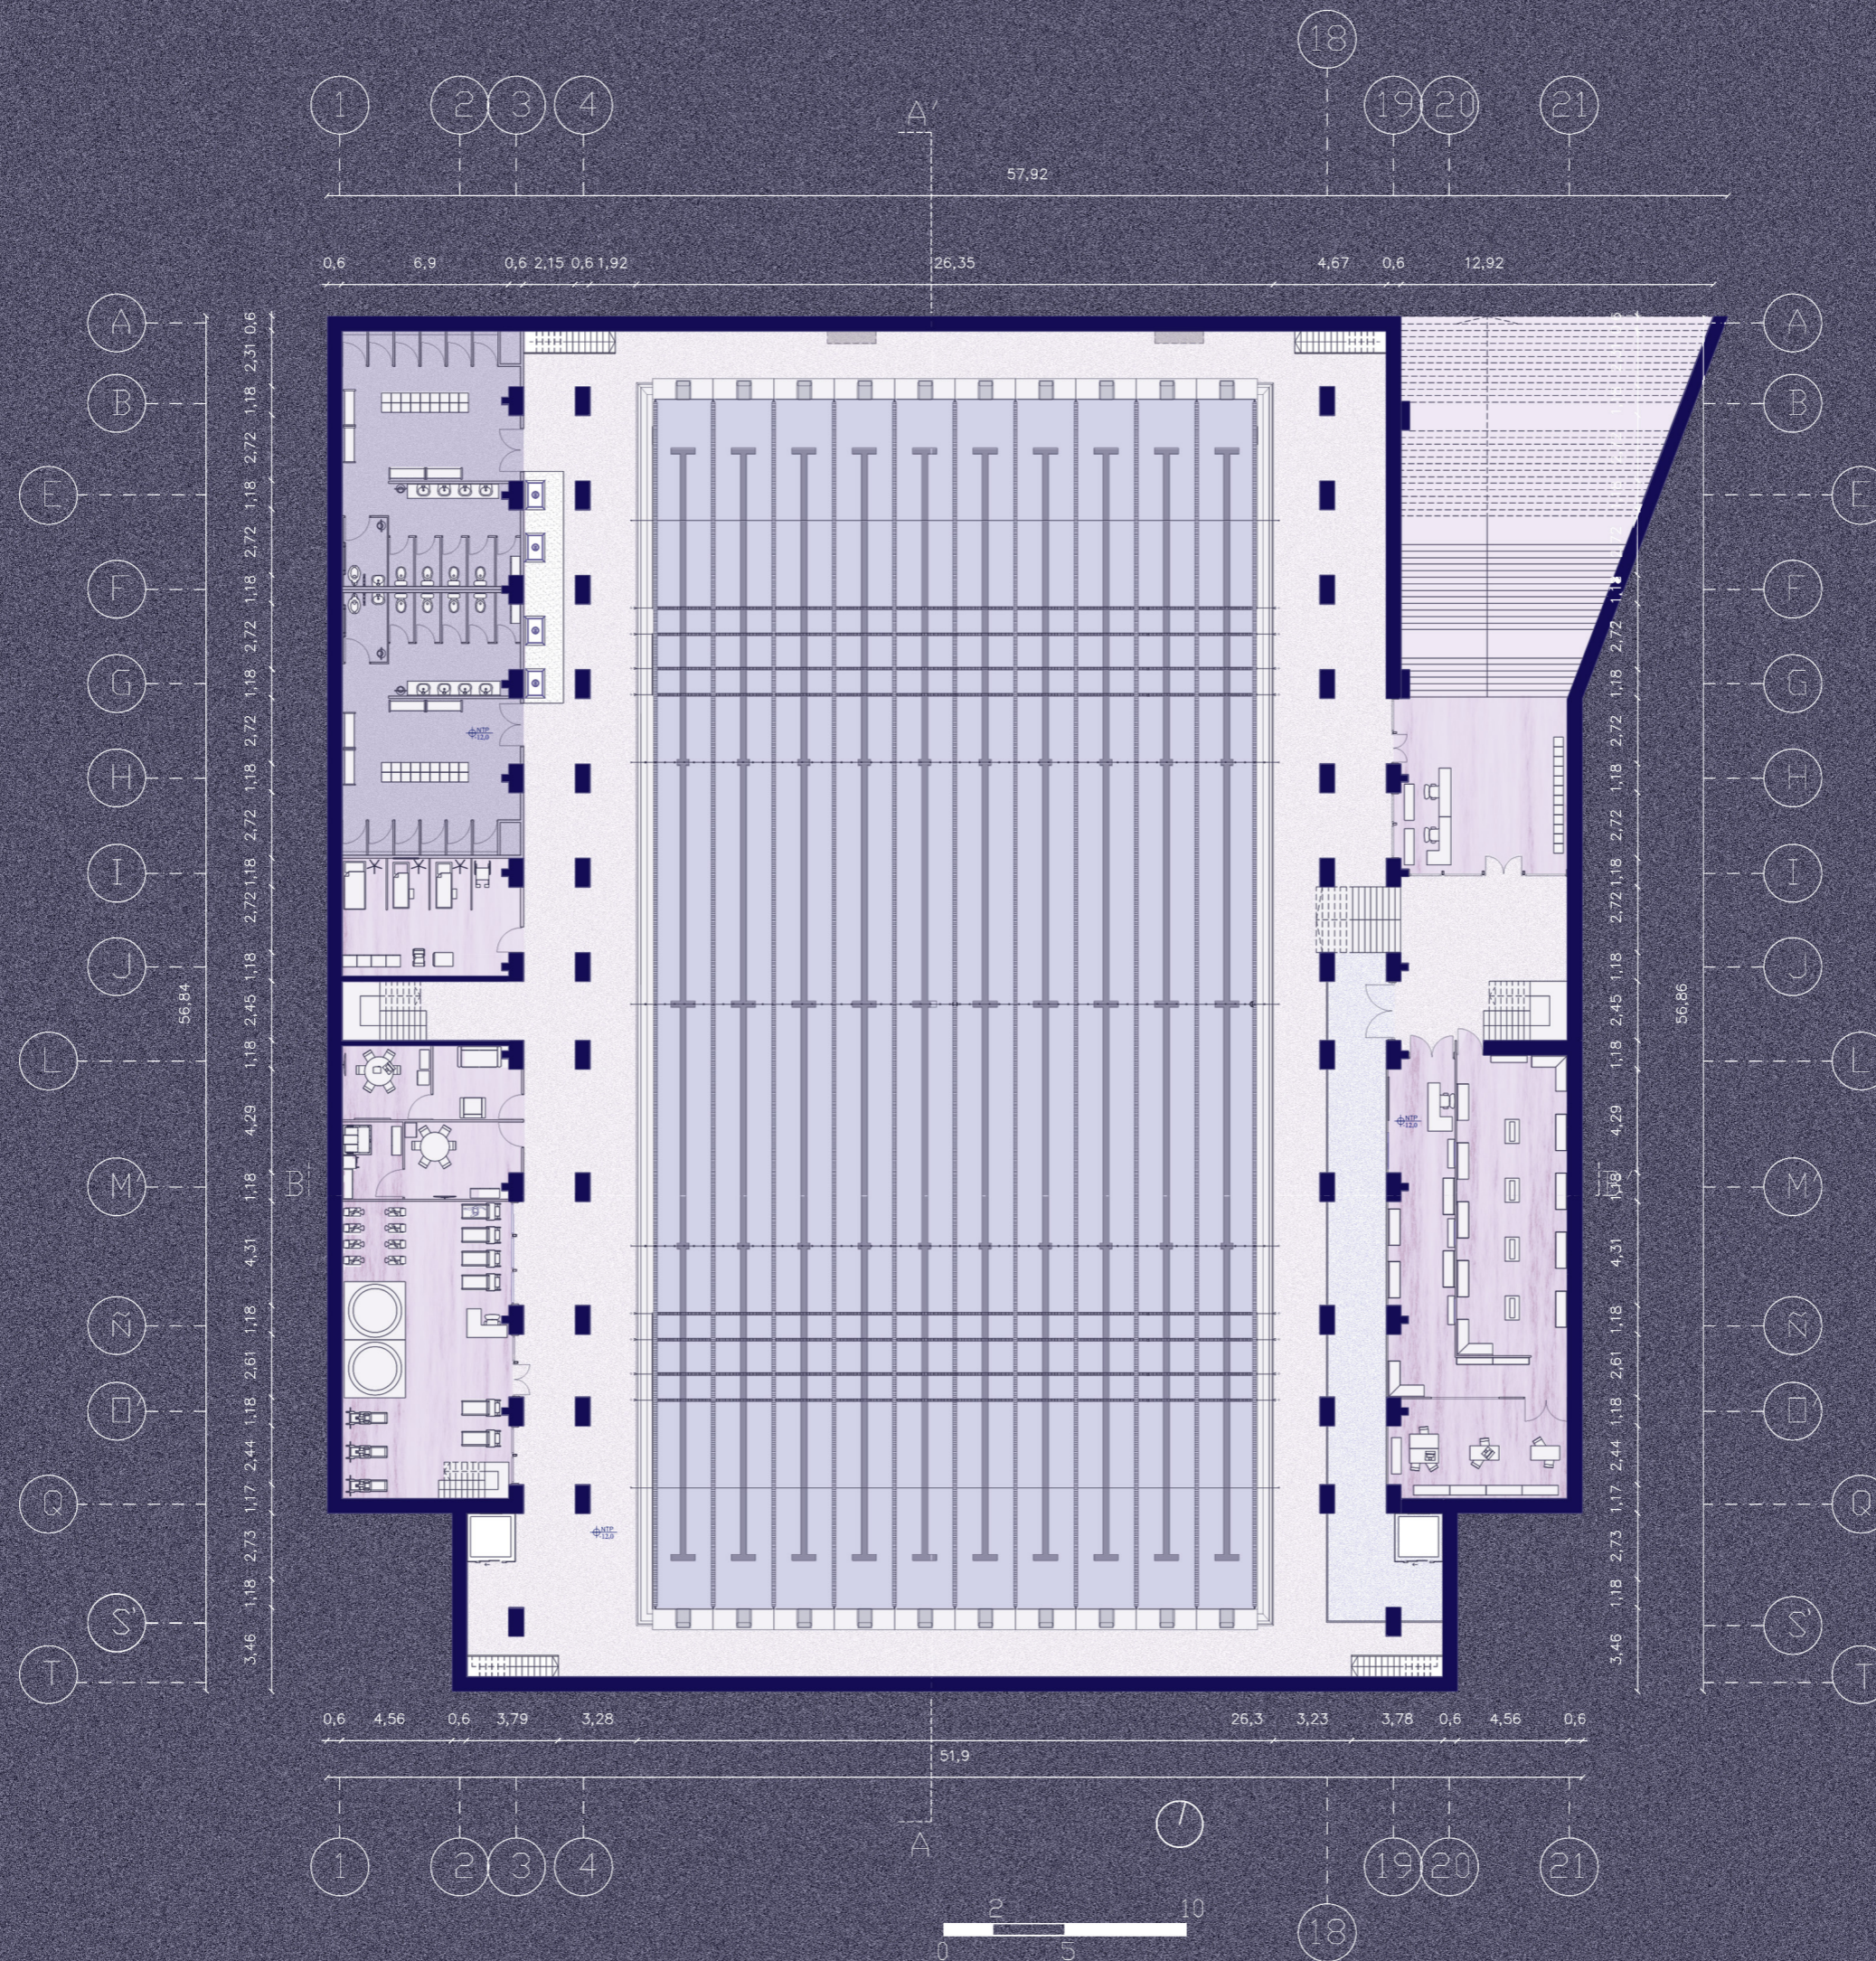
Planta N°-2, nivel -12,0. Fuente: Elaboración propia
